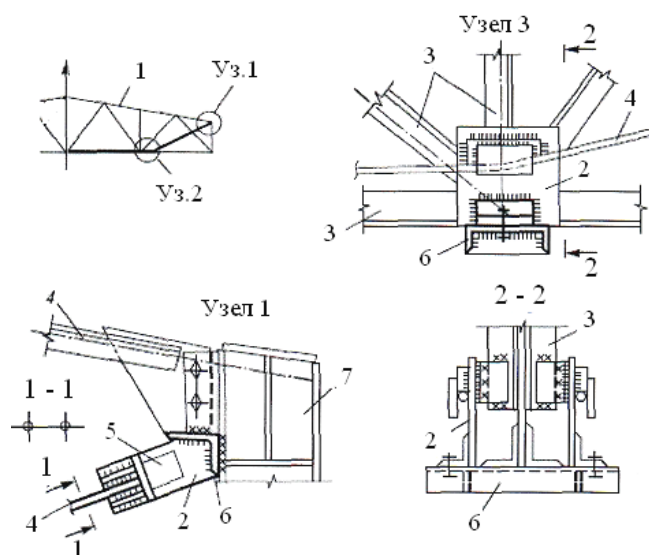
Усиление металлических стропильных ферм установкой предварительно напряженных тяжей:
